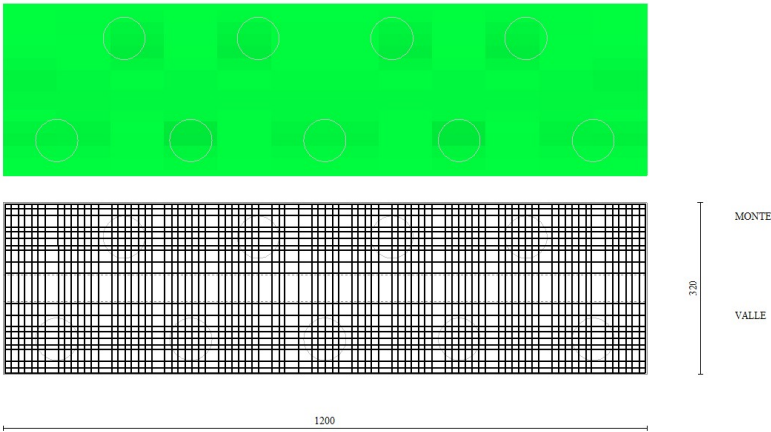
Piastra fondazione dir. Y (Inviluppo)
